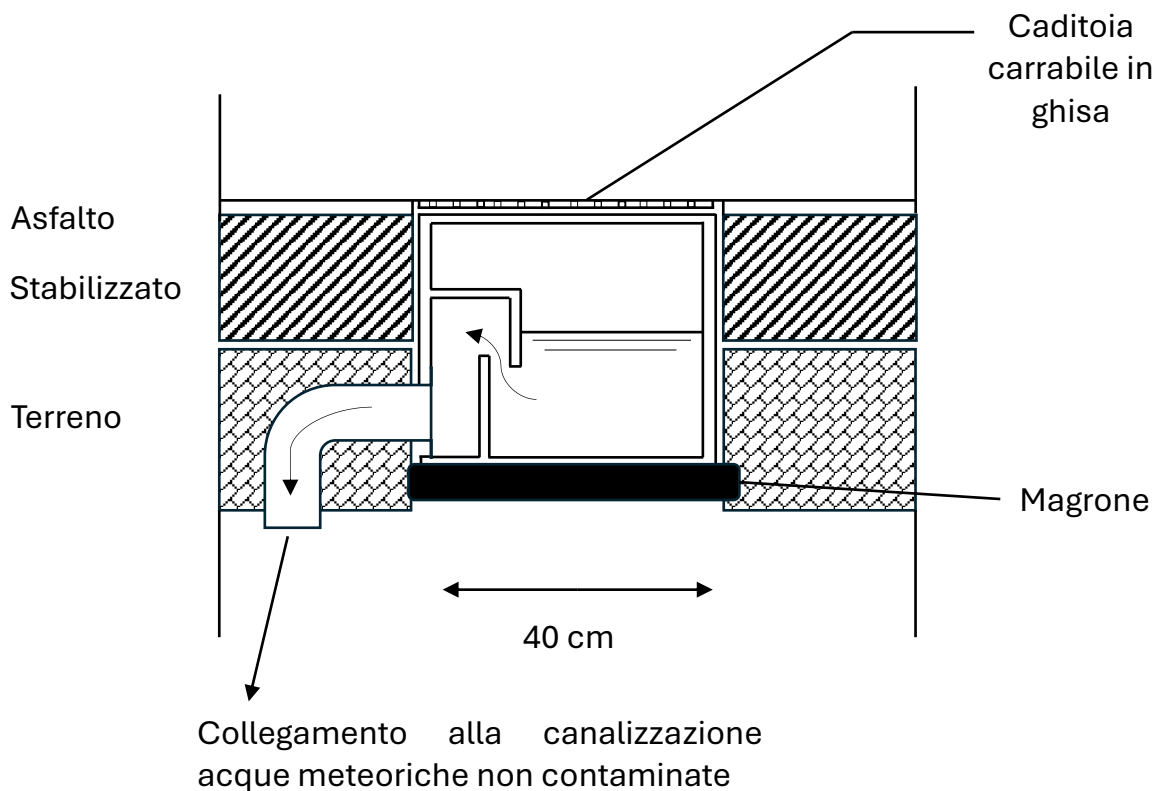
Rappresentazione strutturale pozzetto fiscale, impianto Via Wagner 10, 16159 Genova (GE)
